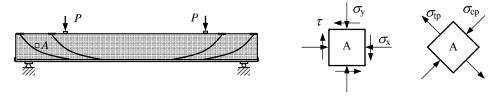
预应力混凝土受弯构件中弯起钢筋附近应力分析
